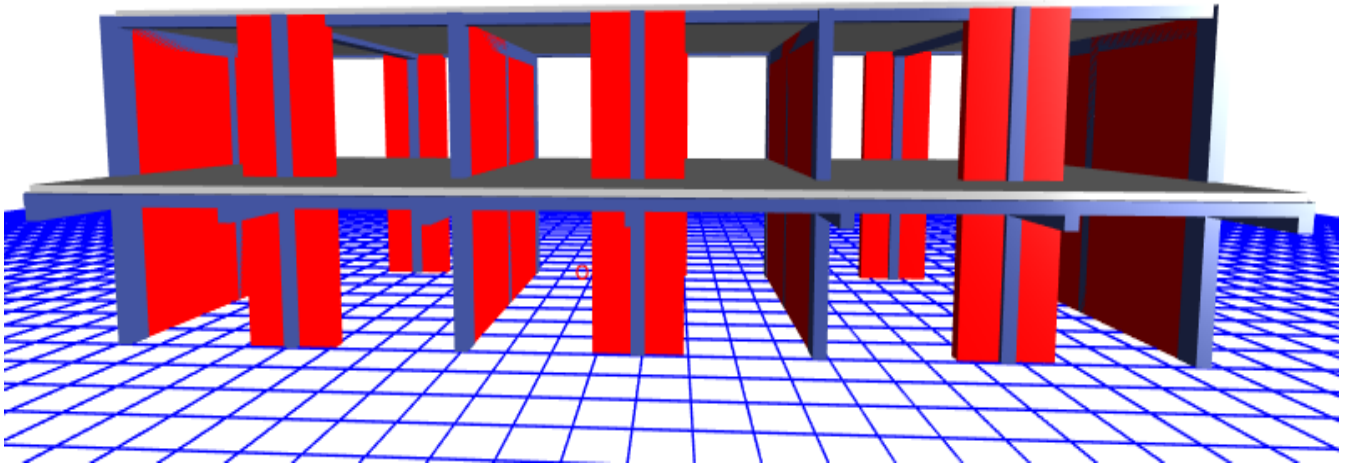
Vista tridimensional del pabellón 4 con placas de concreto armado.
